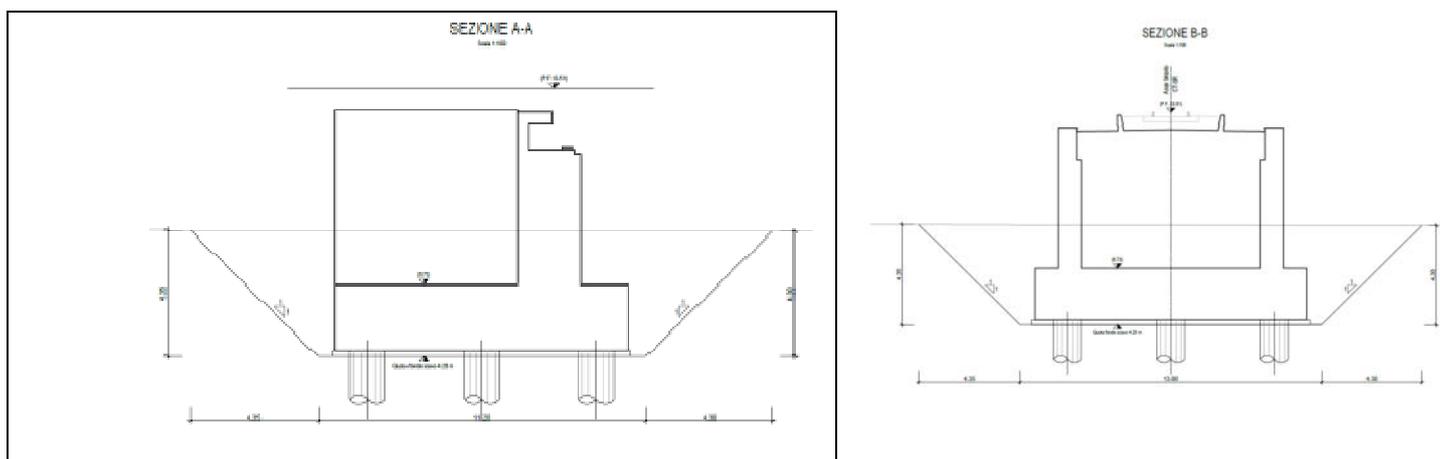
Sezione longitudinale e trasversale della spalla
